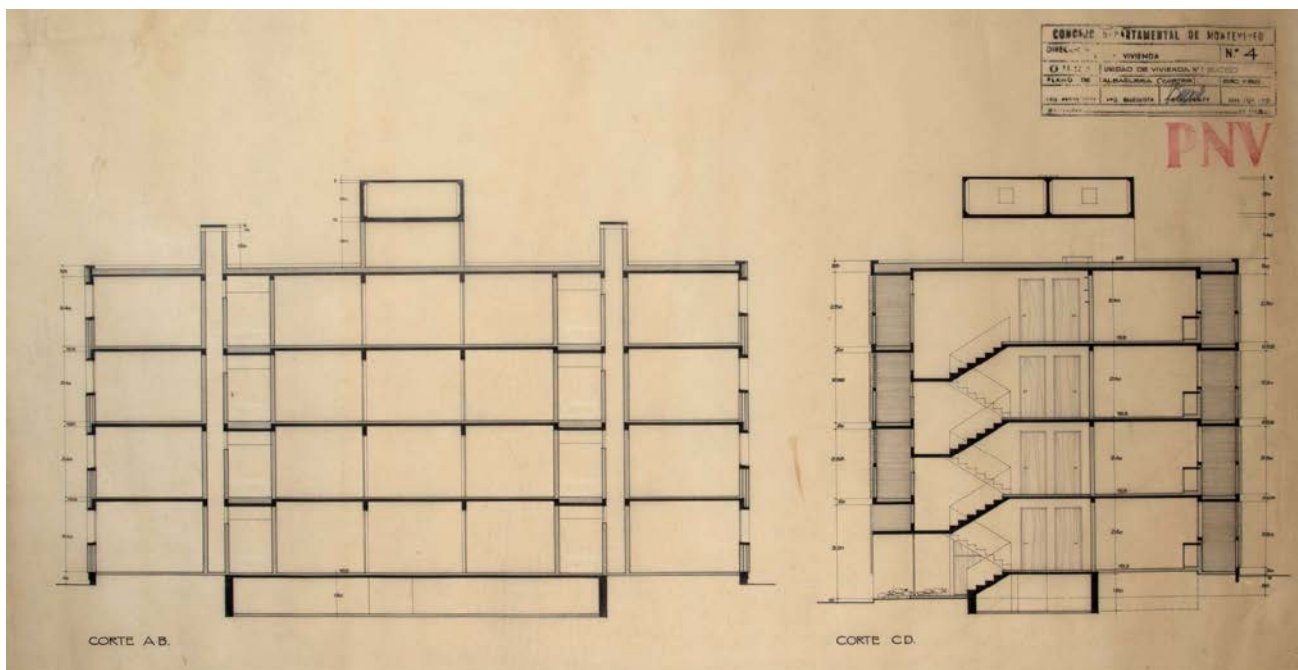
Plano de albañilería (Cortes) de uno de los 32 bloques de viviendas, 1963. Rollo 1 Unidad Buceo. Archivo IM.
